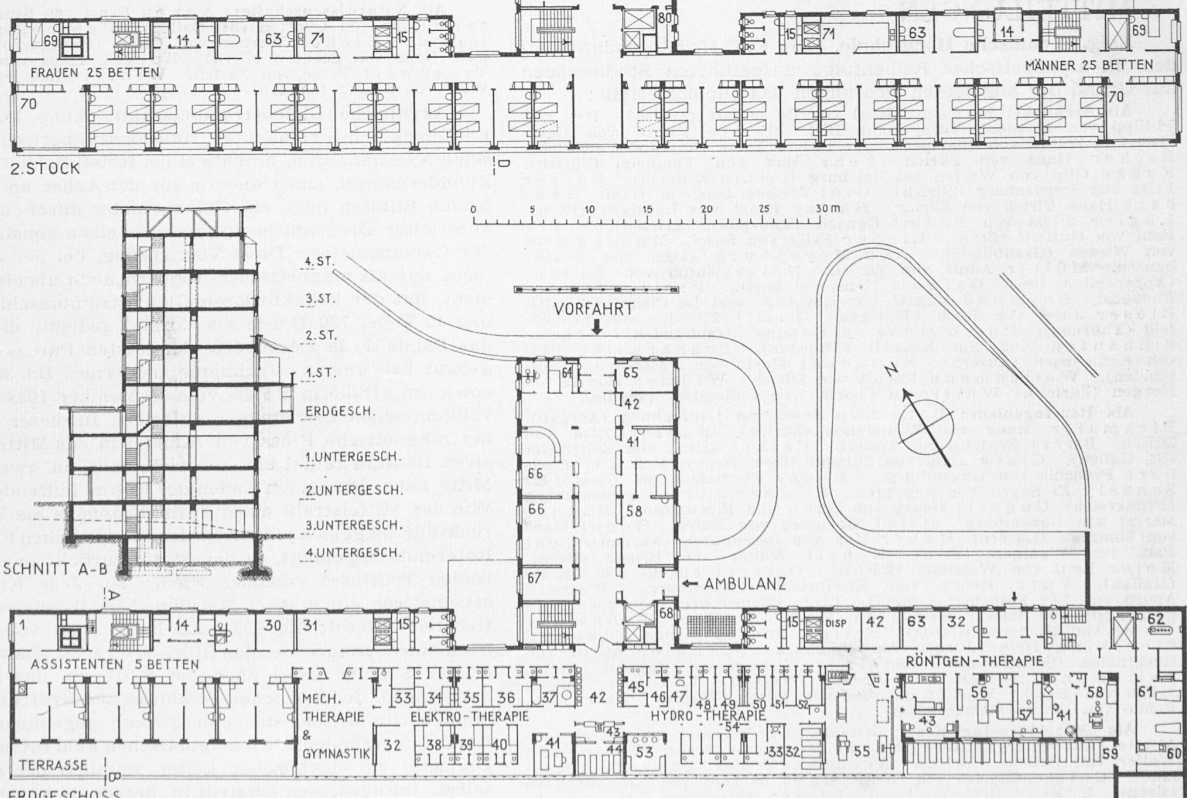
und 5. Grundrisse und Schnitte vom Hauptbau. — Masstab 1 : 600
